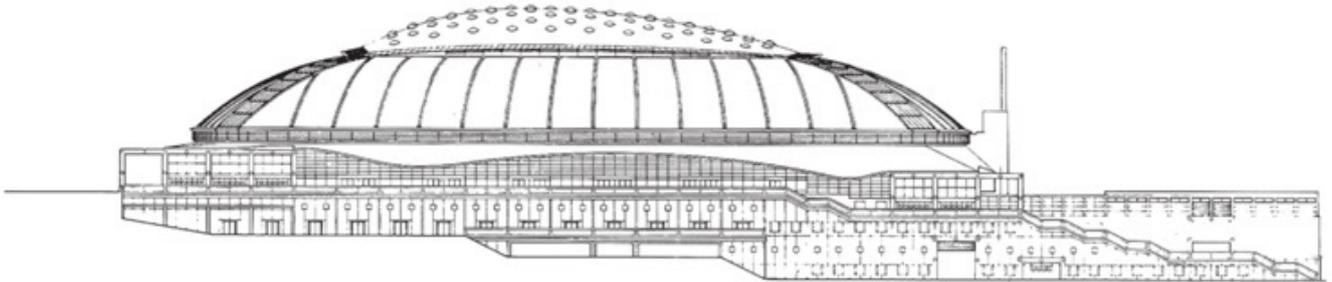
Vista exterior del alzado del Palau Sant Jordi.
